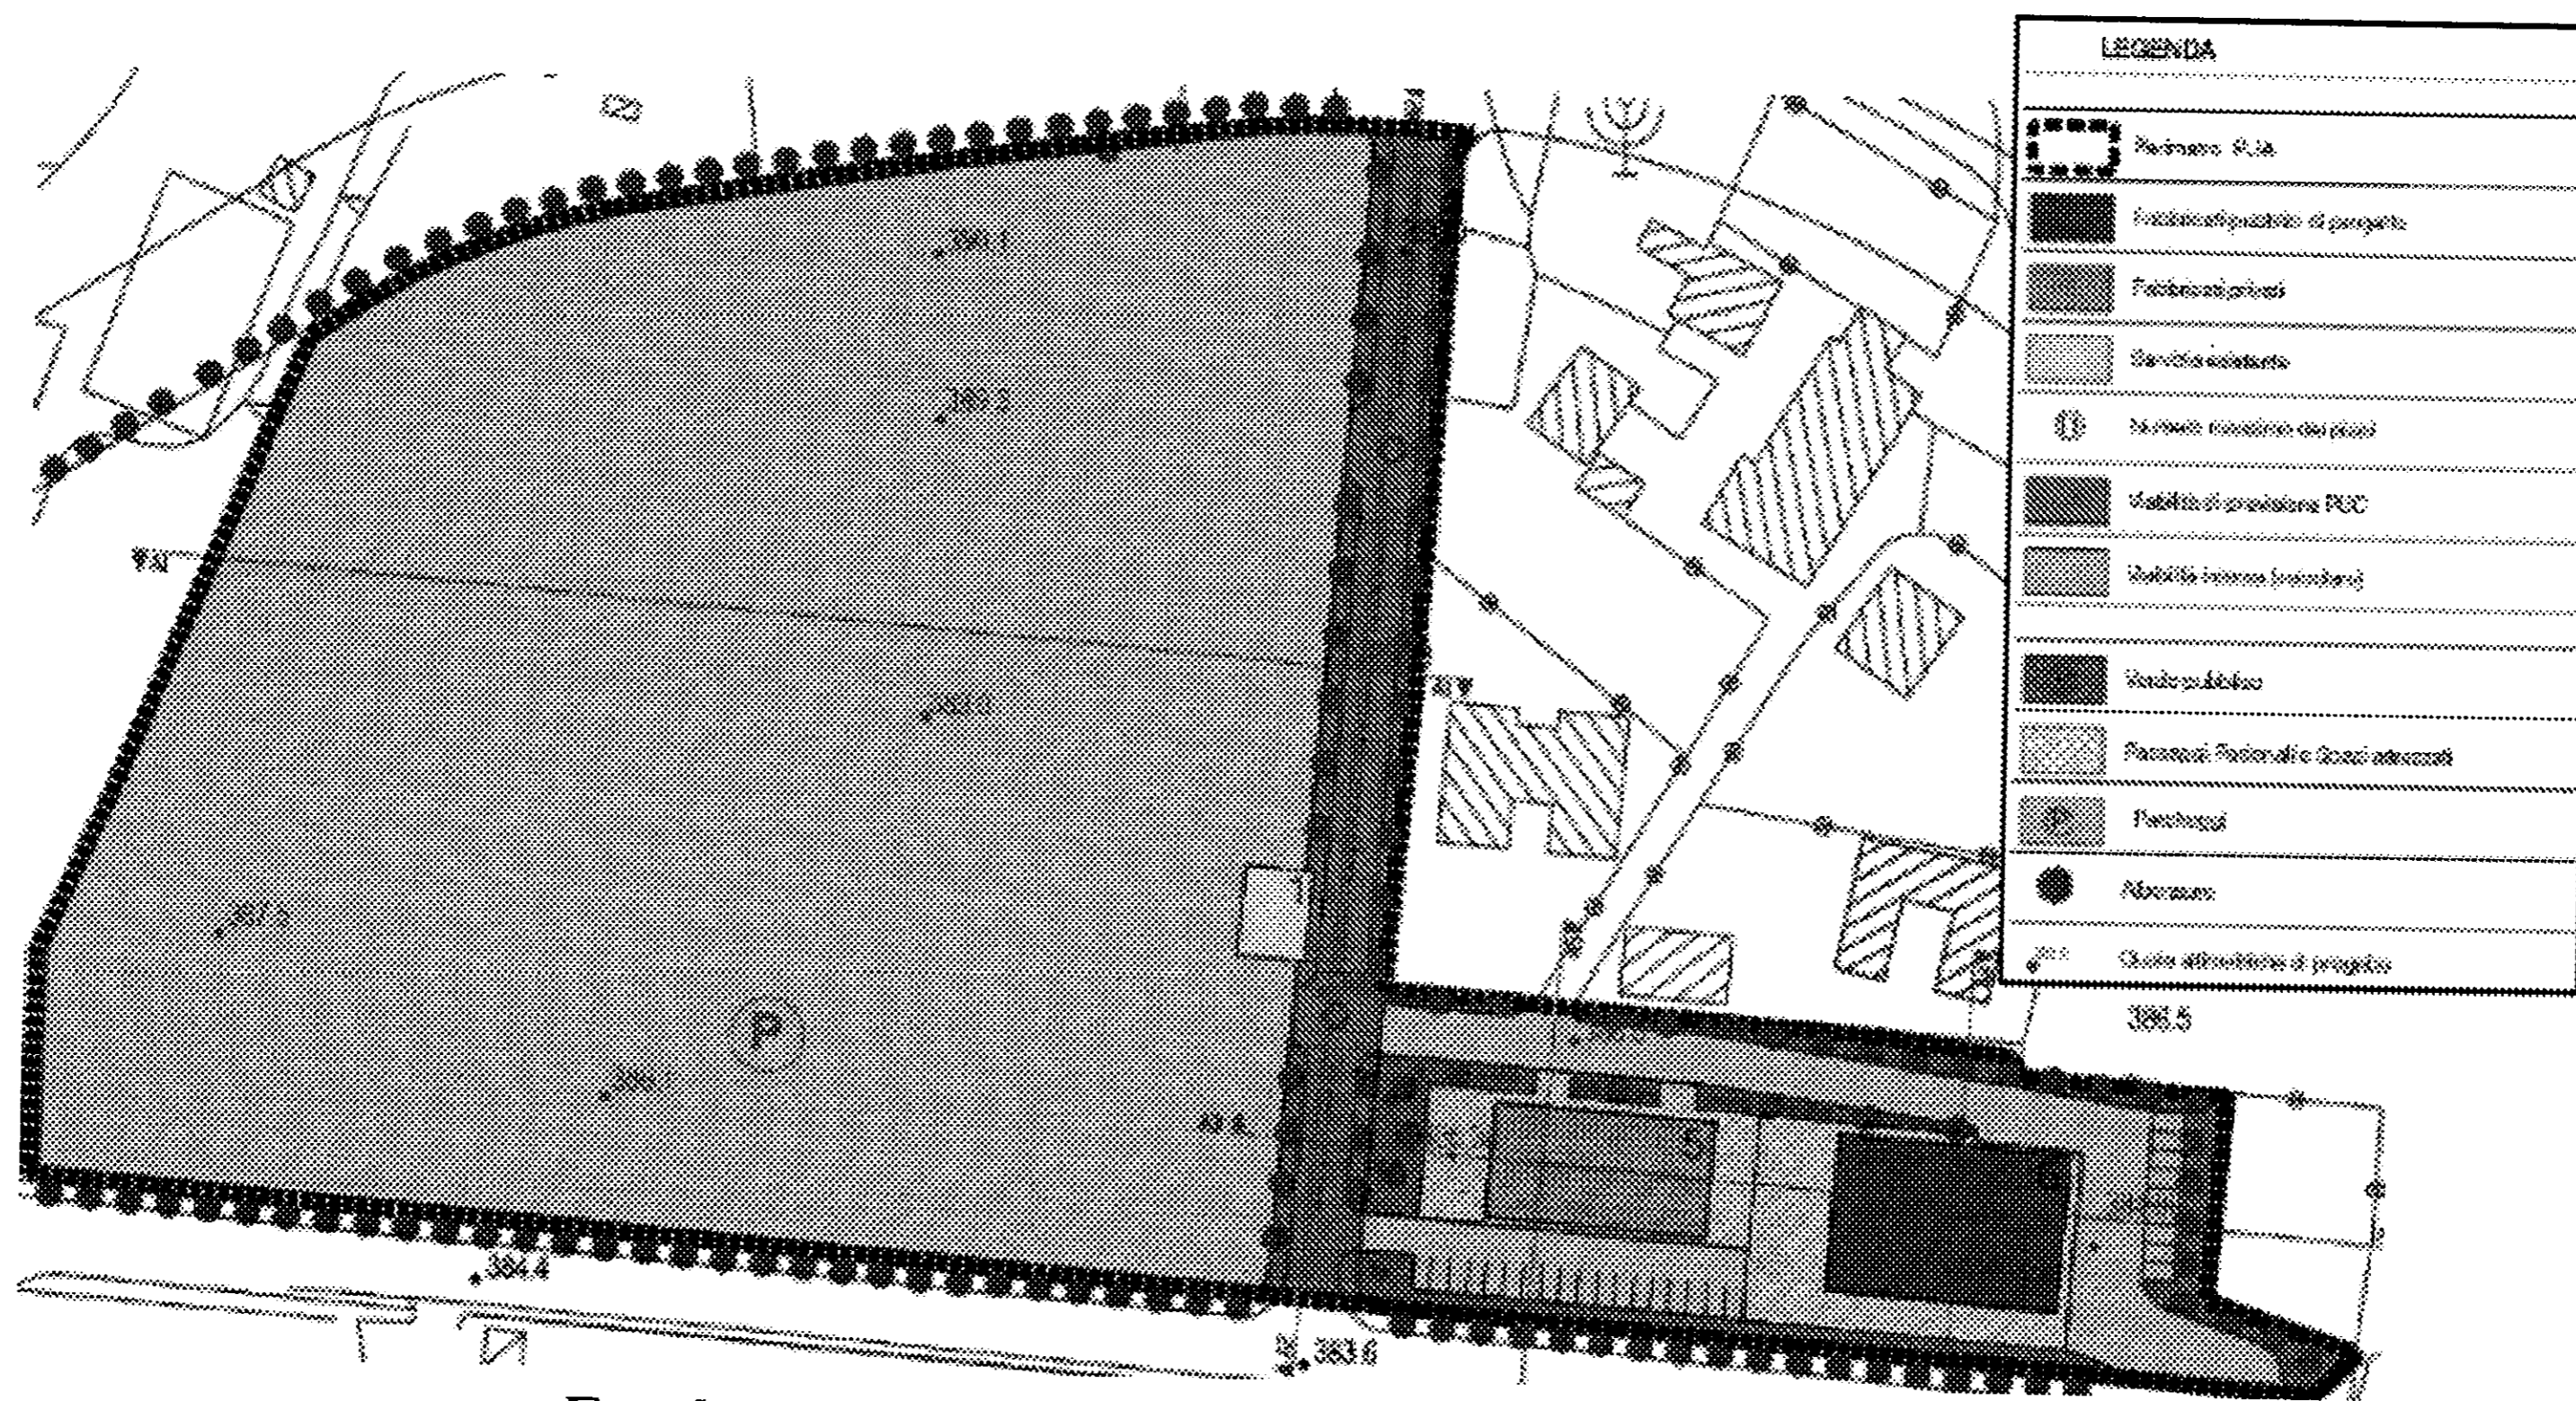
Stralcio zonizzazione area di intervento prevista dal PUA
